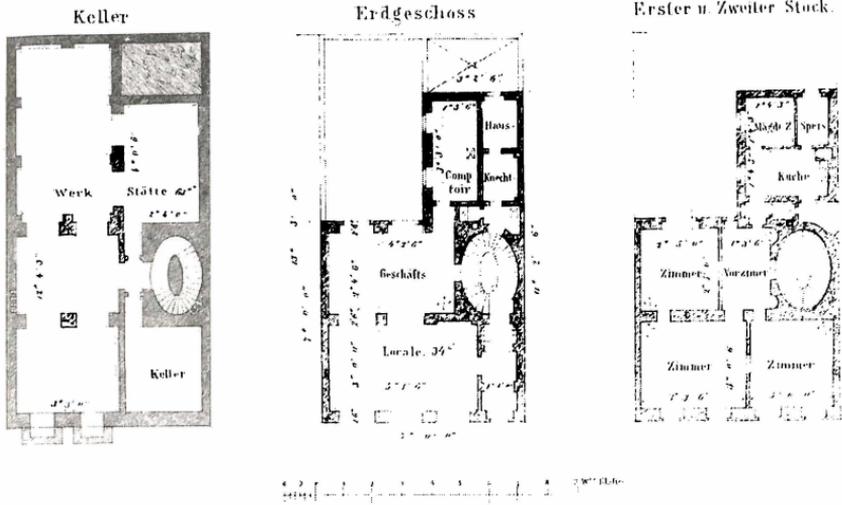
Grundrisse des "bürgerlichen Wohnhauses"
